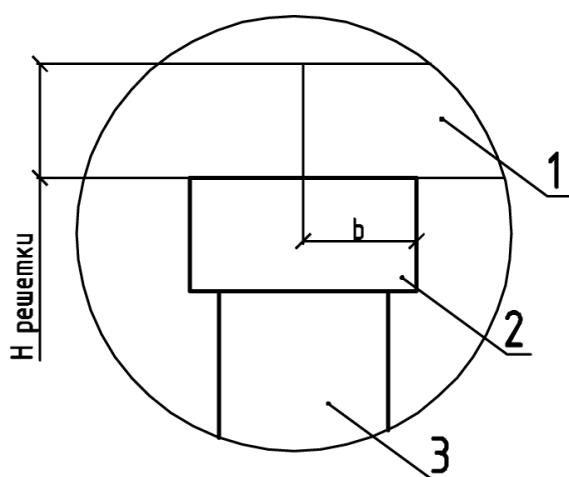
Схема опорной конструкции для монтажа придверной решетки
